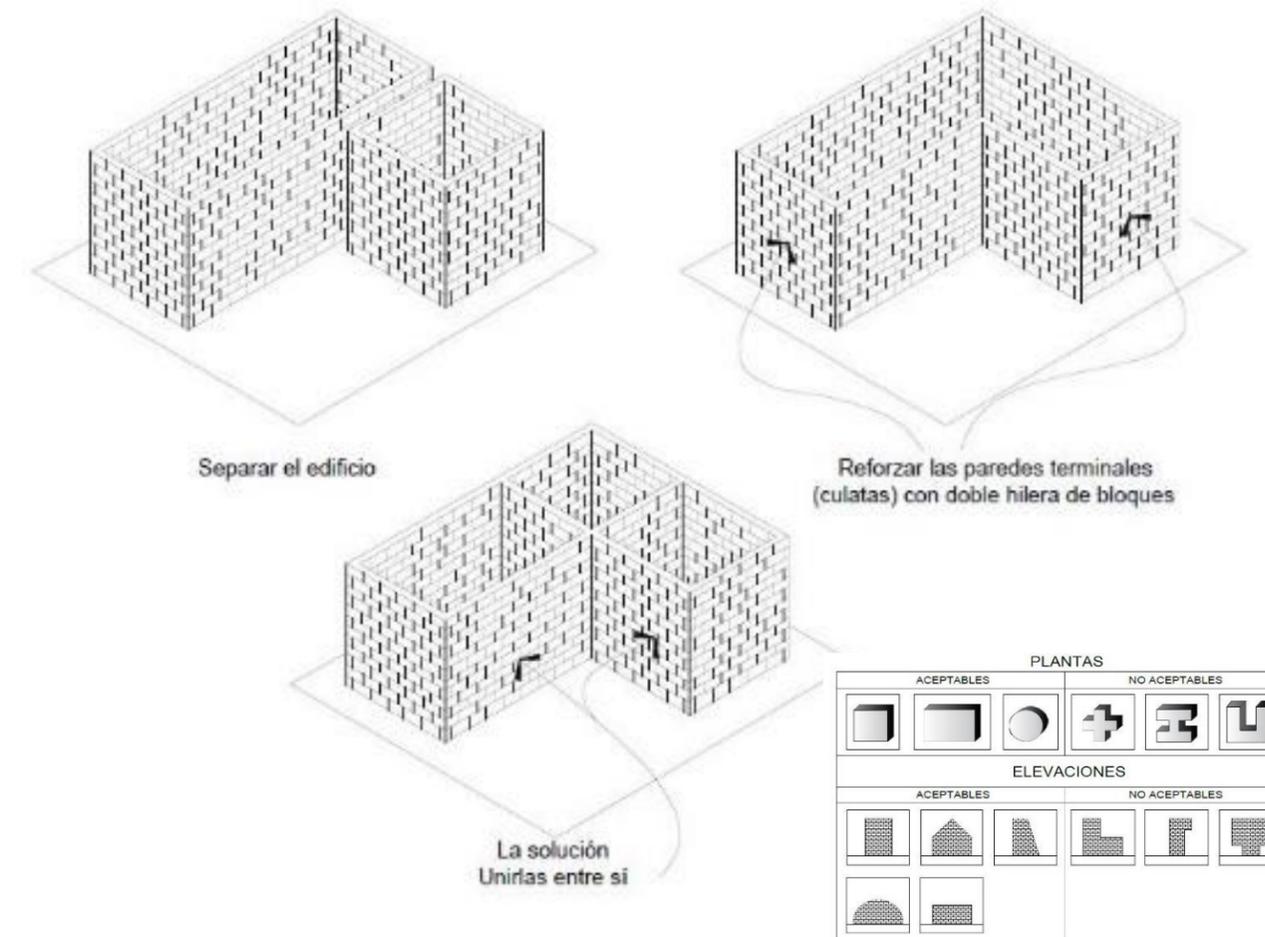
Forma de las plantas y elevaciones recomendables.
